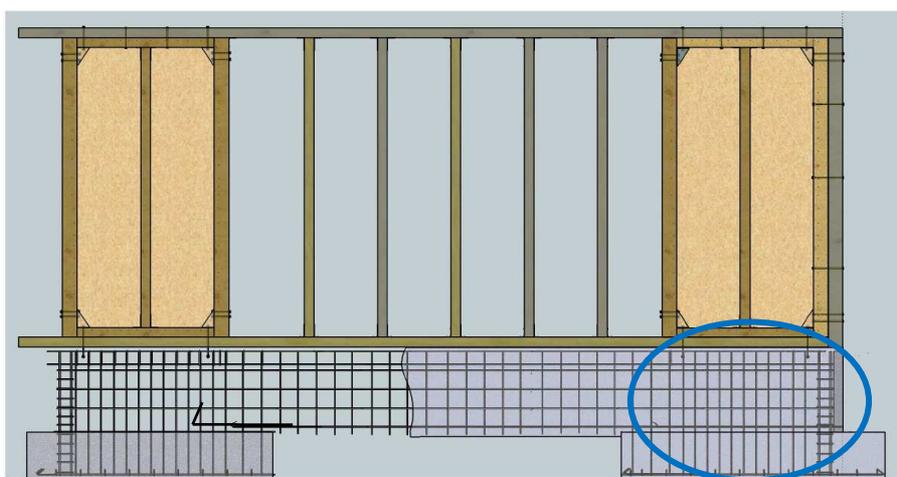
Panneaux de contreventement VT sur fondation de type semelle isolée. Le ferrailage est renforcé sous les panneaux de contreventement : espacement des cadres 15 cm maximum.
